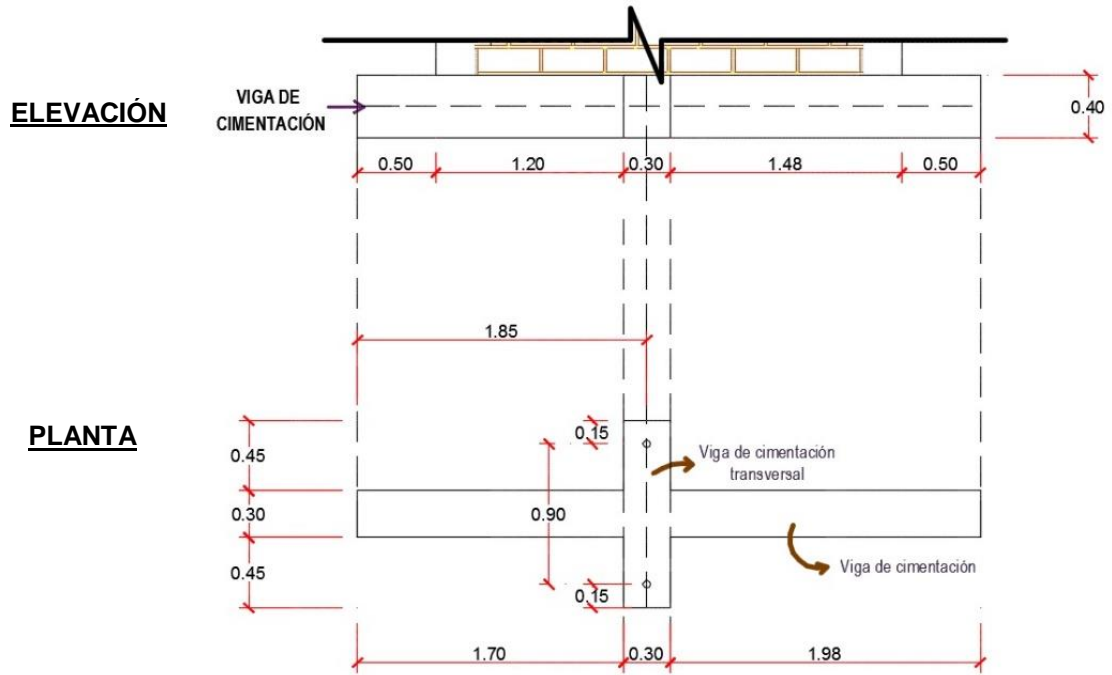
Detalle de la viga de cimentación: Elevación – Planta
